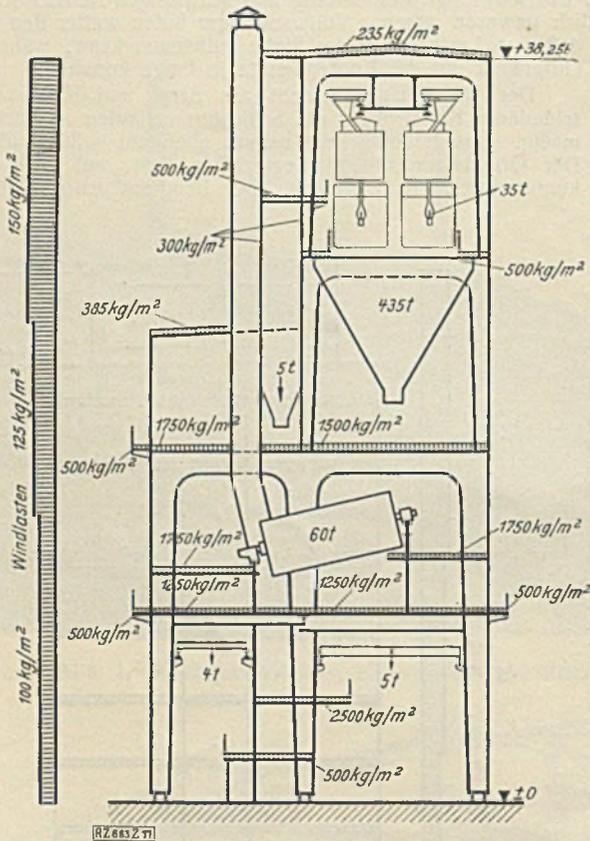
Querschnitt durch die Kohlenmahanlage mit eingetragenen Lasten.
